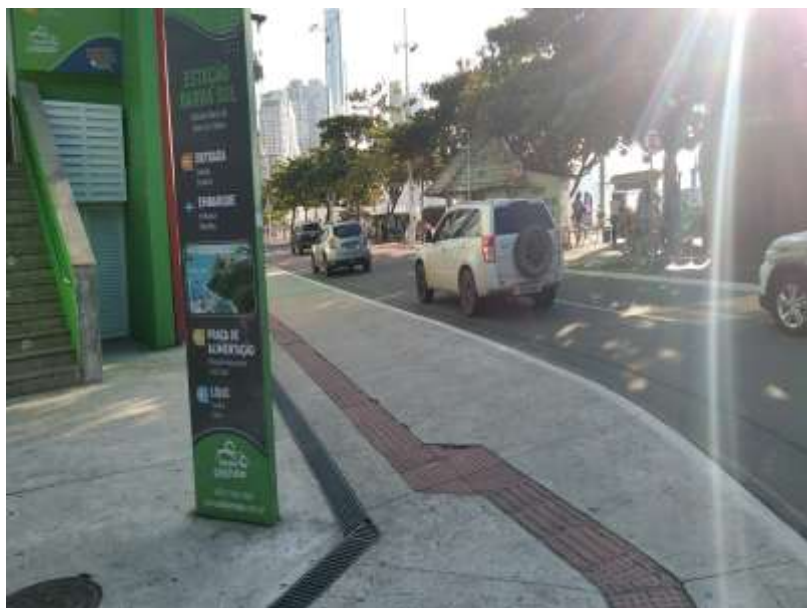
Calçada com piso podotátil, existente na Avenida Atlântica, defronte ao acesso da estação barra sul..
